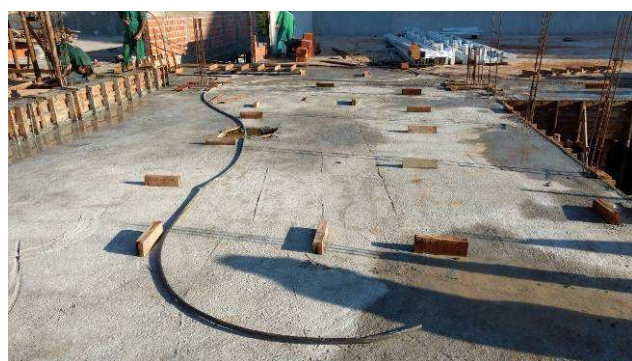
C: Concretagem das lajes e vigas de cobertura concretadas - eixos 4-6 e E-H.
